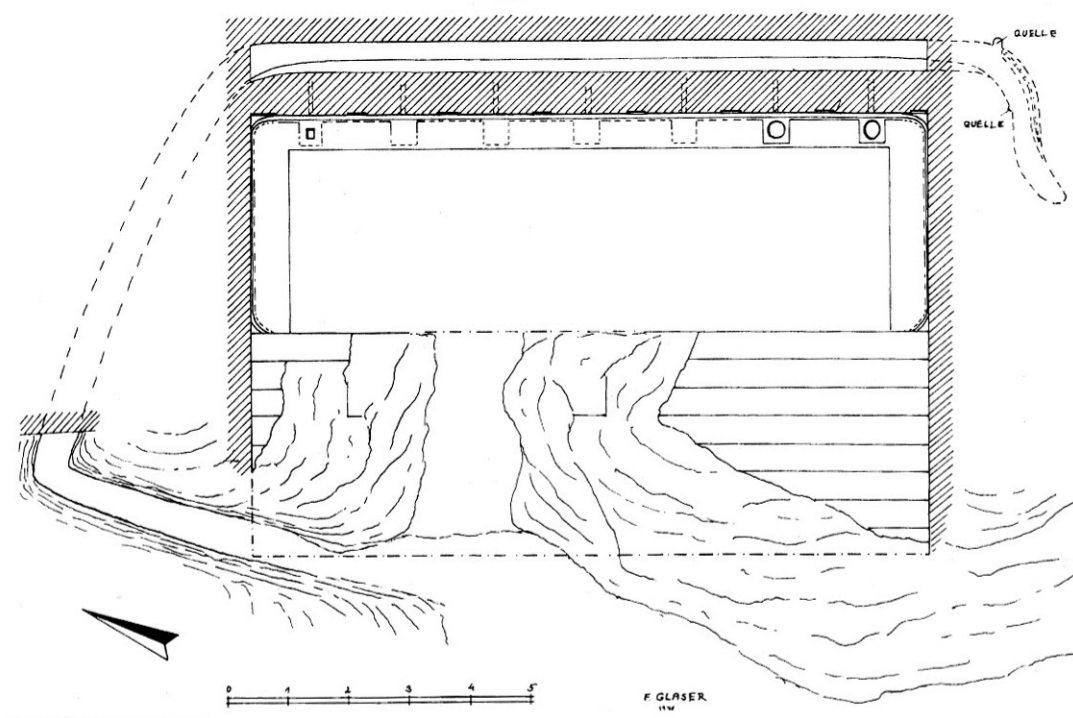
Castalia II. Planta y fachada de la fuente rupestre
